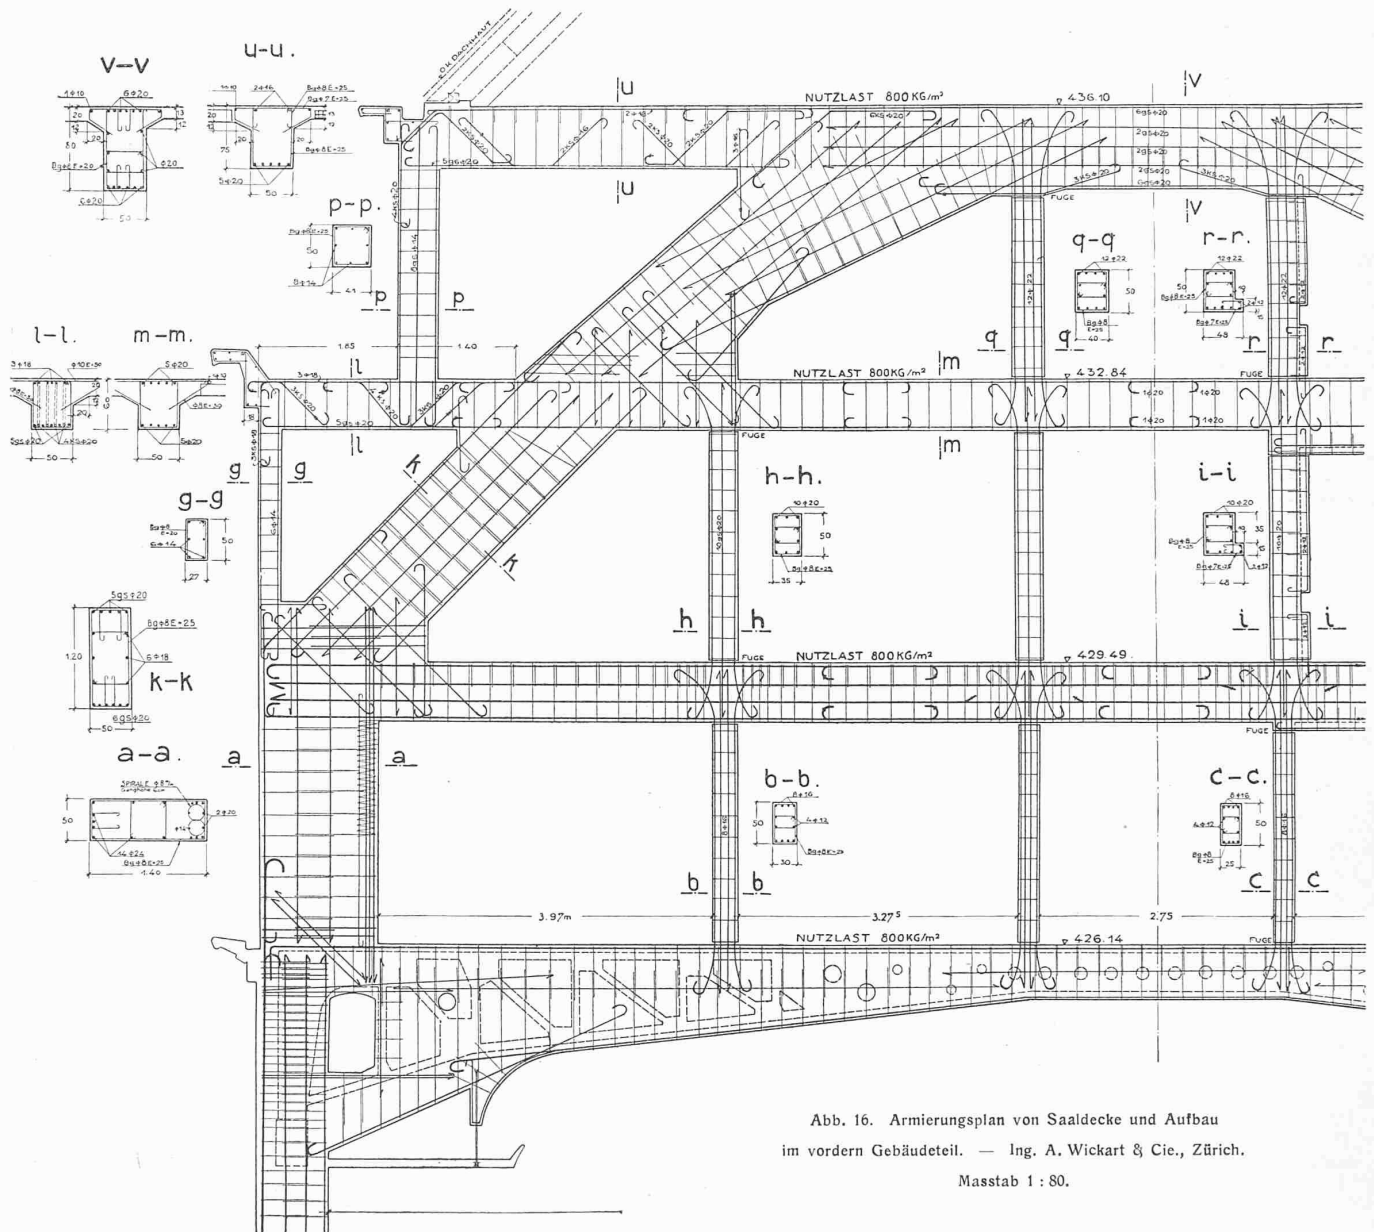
Armierungsplan von Saaldecke und Aufbau
